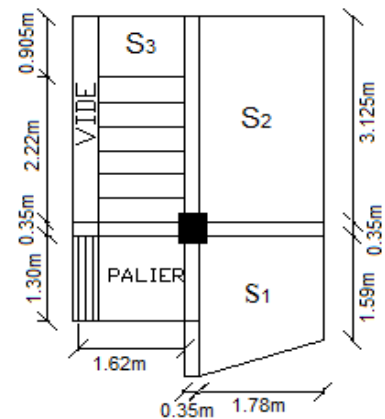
Surface afférente du poteau P2 (N3 à N12)
